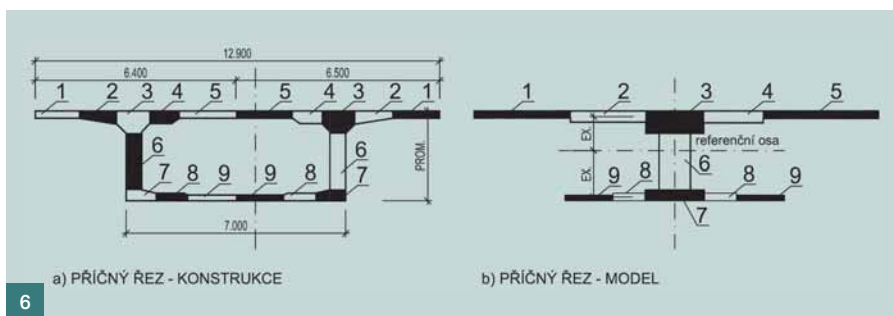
Příčný řez a výpočtový model D9 ■ Fig. 6 Cross-section and the structural model D9
